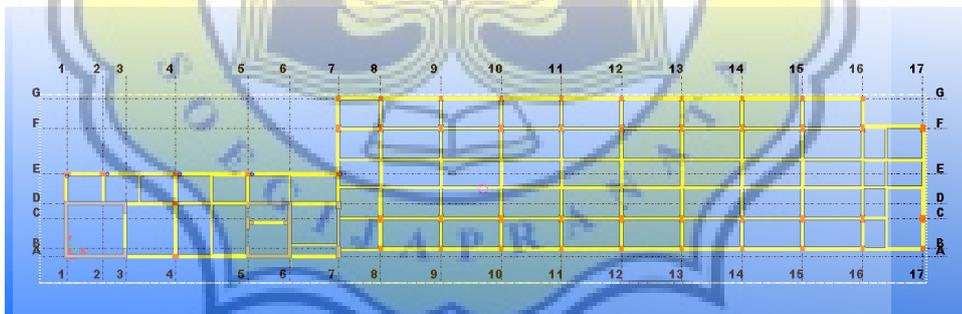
Tampilan *Create Concrete Beam* pada *Concrete Toolbar
